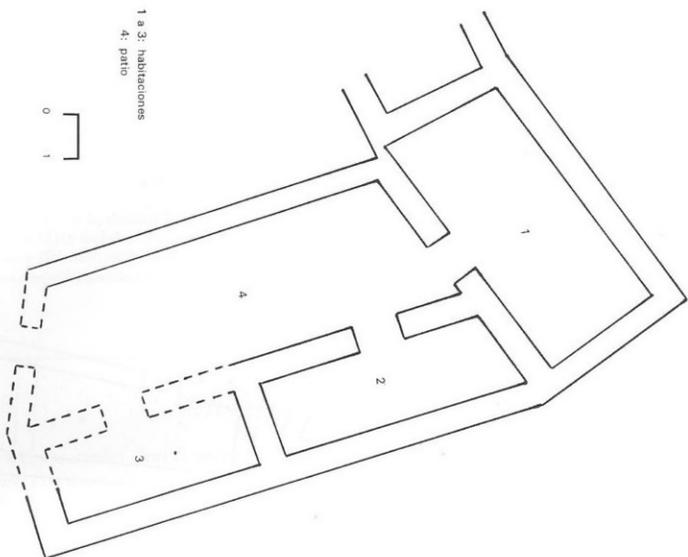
Plano esquemático de una vivienda de Yaros (casa n.º 3)
